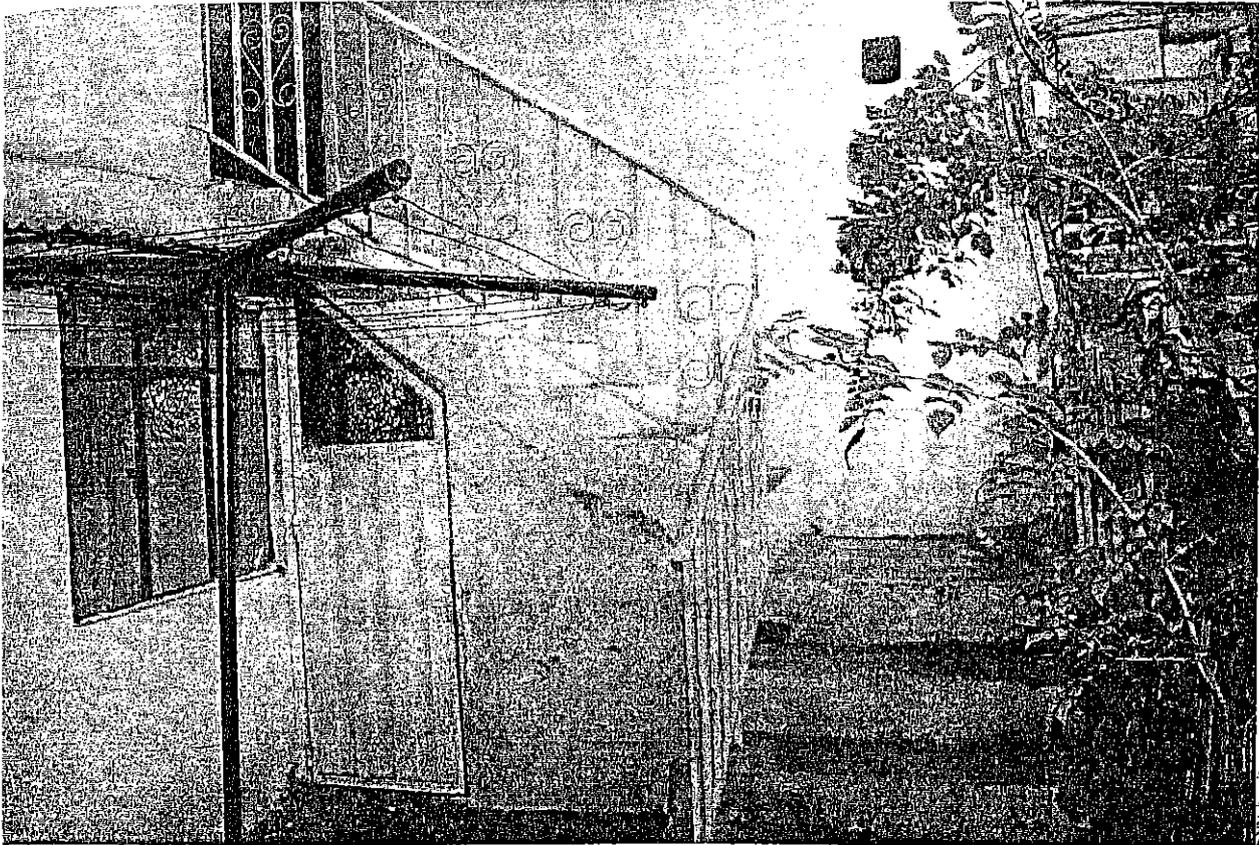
Fotografía de semi-conjunto, en la que se aprecia las gradas de acceso a la segunda planta del inmueble.
